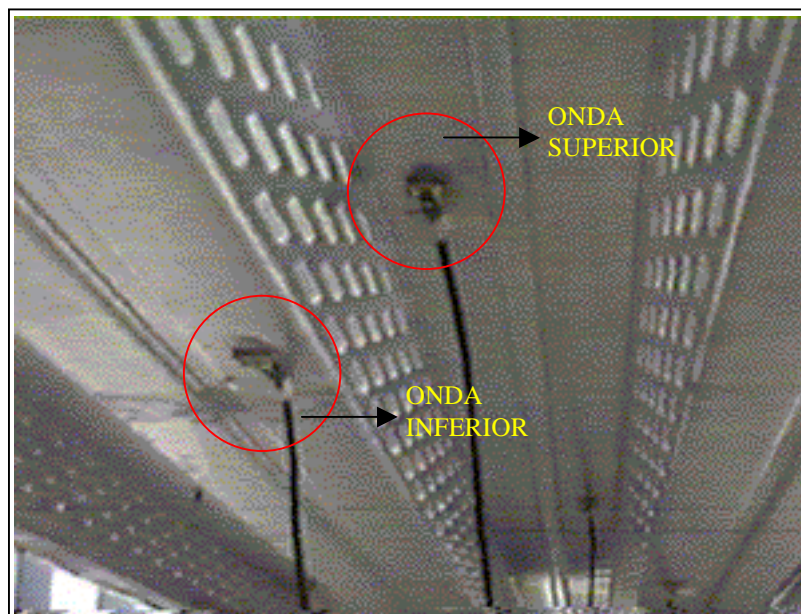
Detalhe da localização dos extensômetros no “steel-deck”
